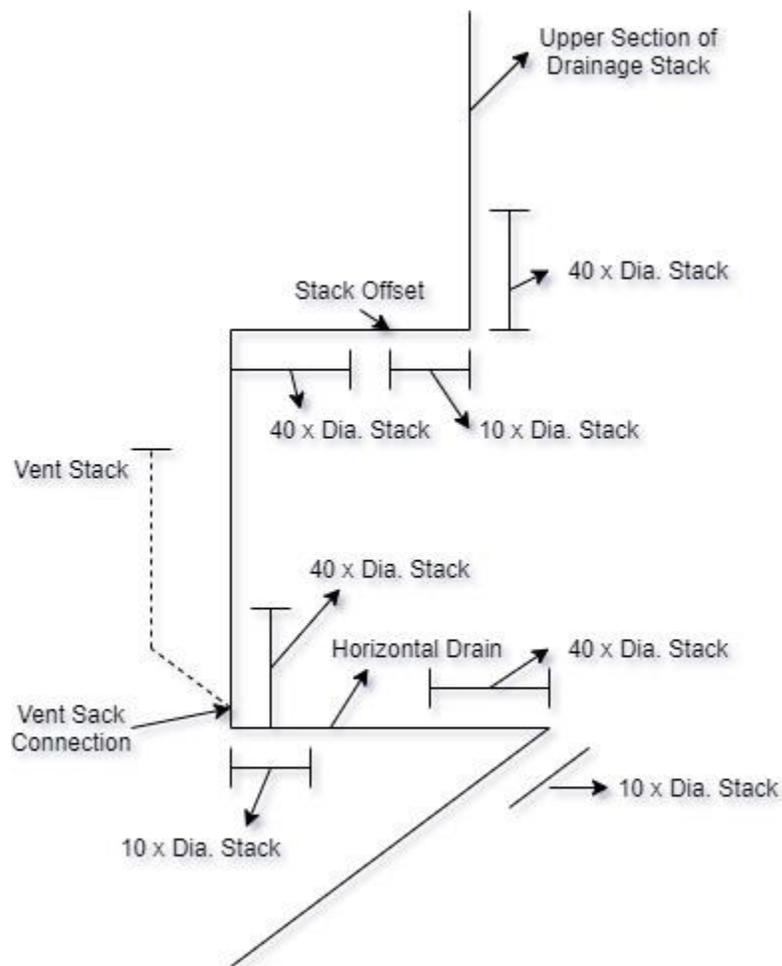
Zonas de presión de espumas en sección de tubería de drenaje tomado de (Officials, *New York Plumbing Code*, 2014)
